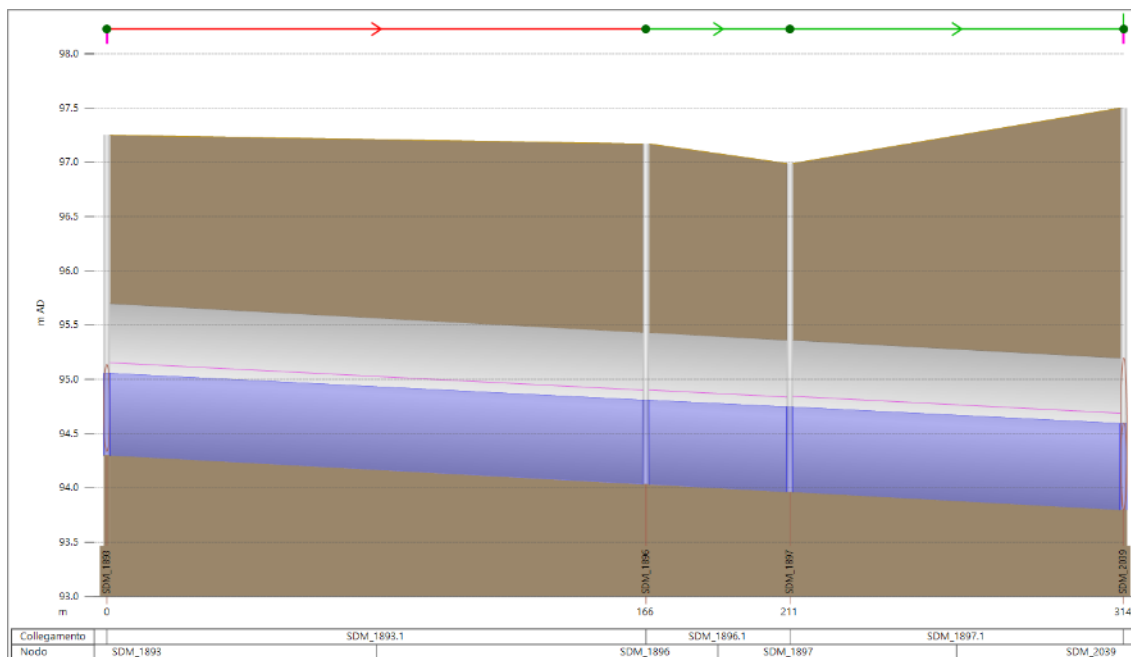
Profilo di progetto tratto di dorsale centrale in zona ospedale
